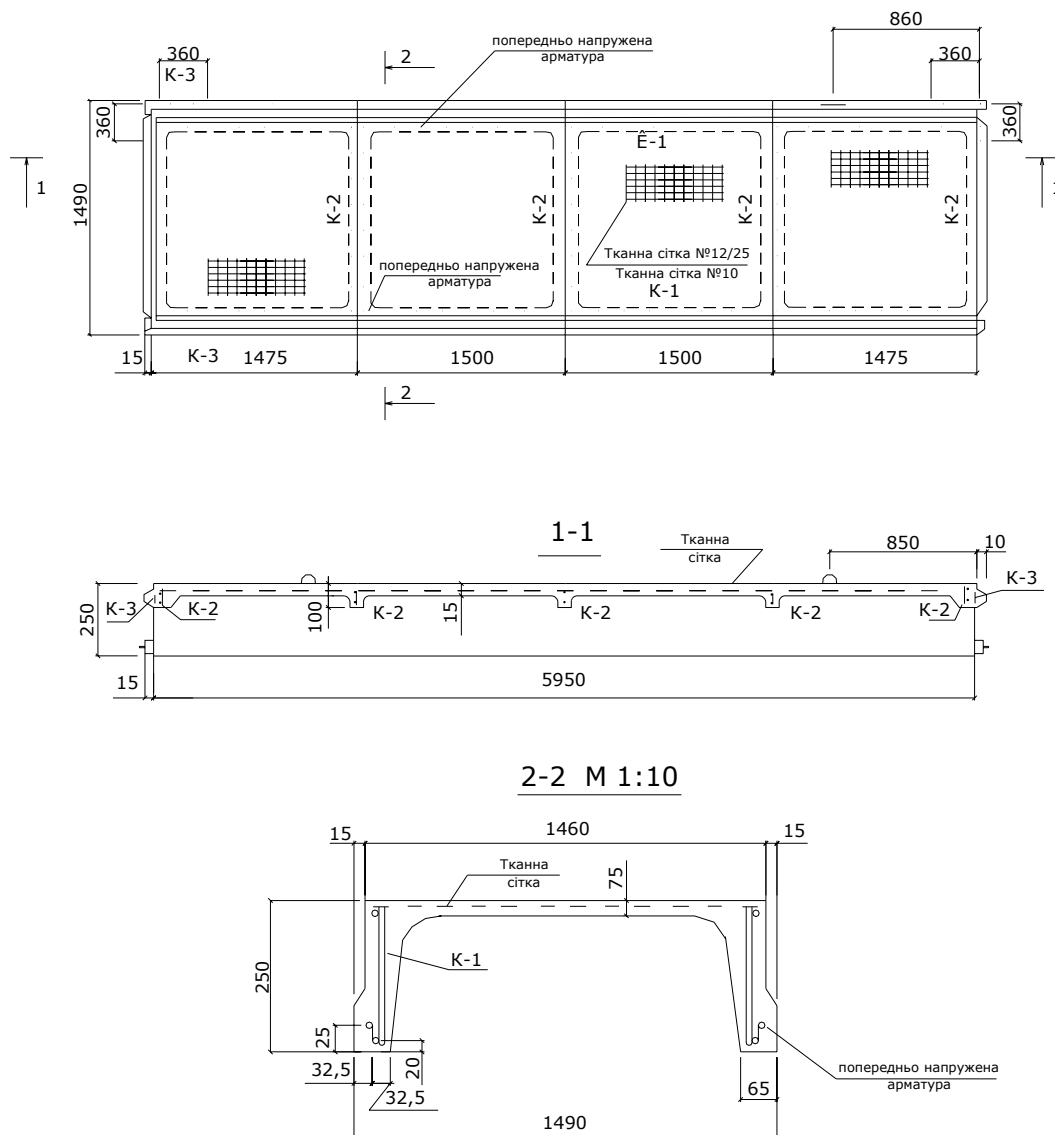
Конструкція армоцементної панелі покриття для сільського промислового будинку
